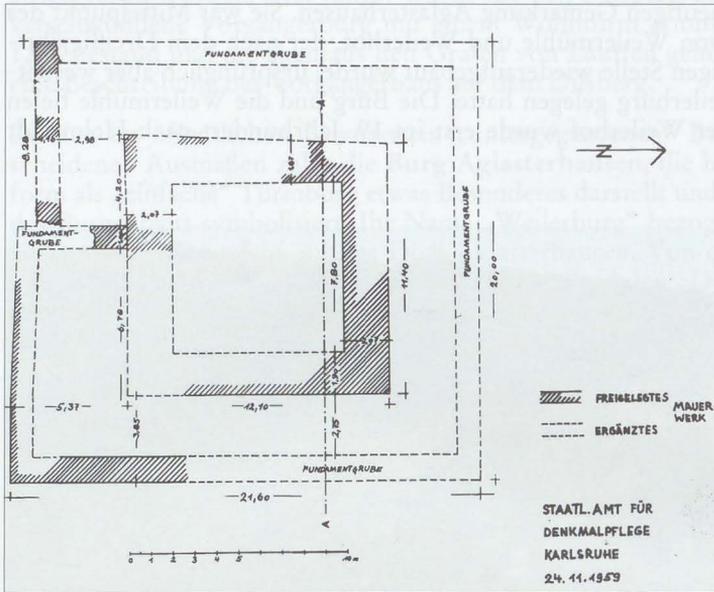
Grundriss der Burg, ermittelt 1959.
